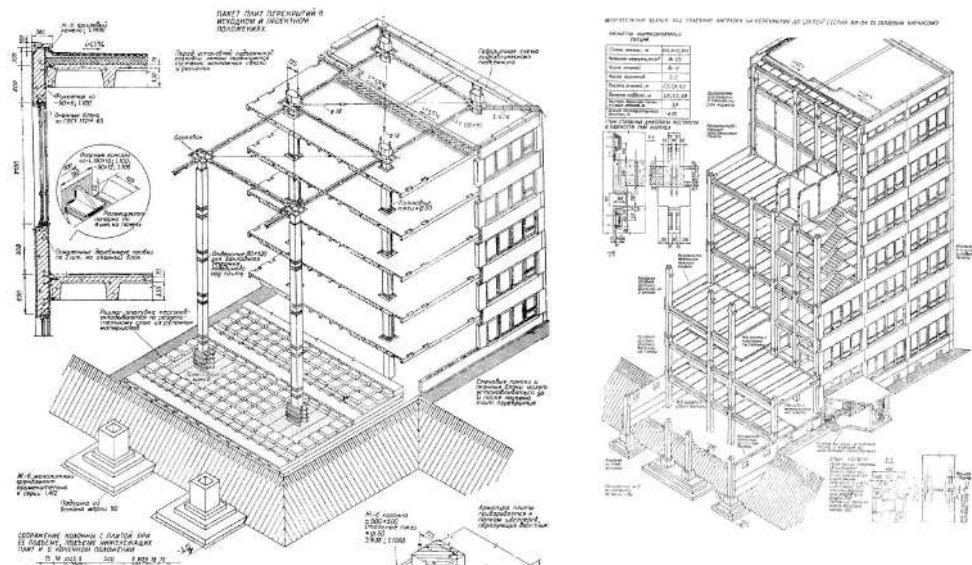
Конструктивна схеми багатопверхових будівель під різне навантаження на перекриття. [78]
